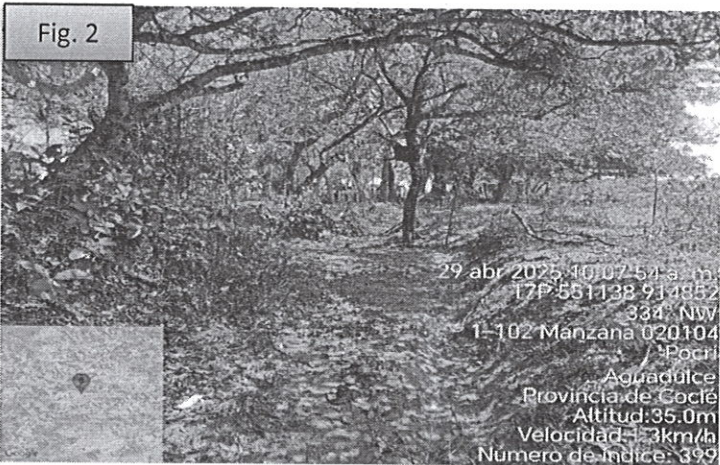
Se muestra el drenaje pluvial, colindante con el polígono del proyecto.
